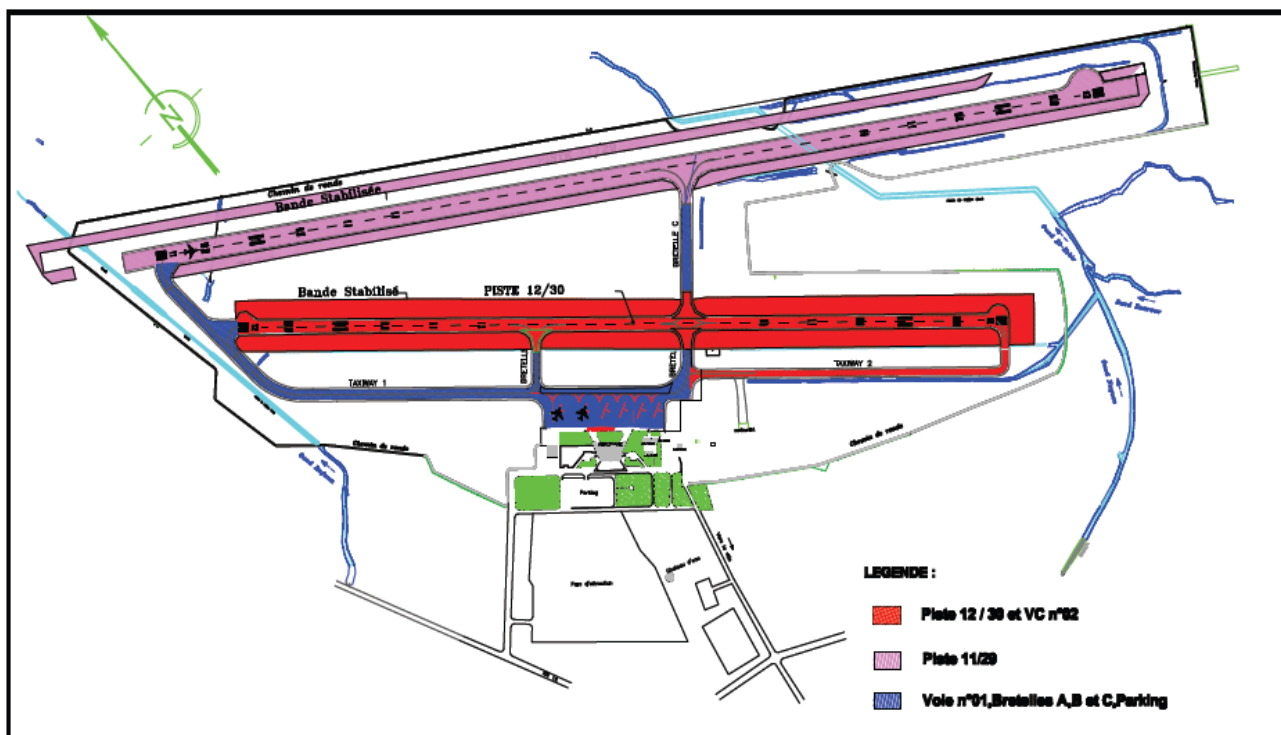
5.1.3 Plan de masse de l'aérodrome
